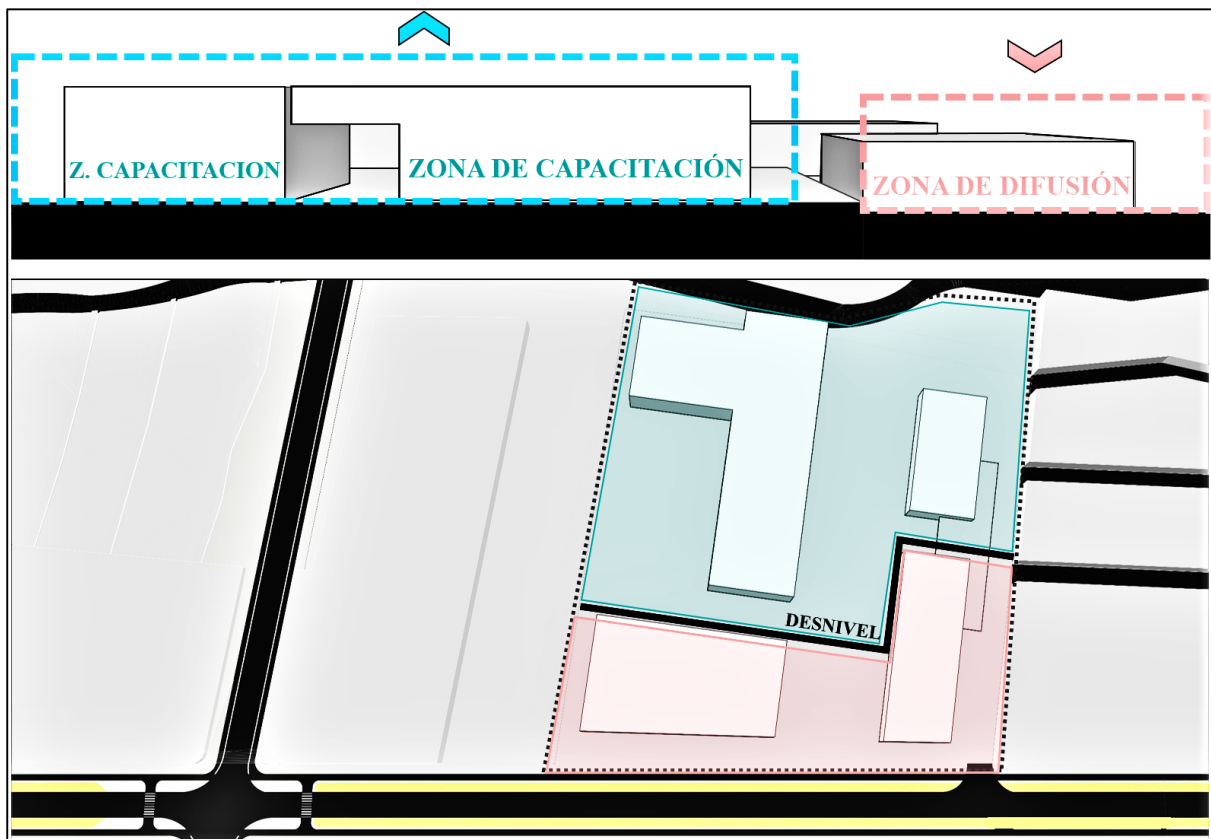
Sección y Planta esquemática del emplazamiento del terreno. Elaboración Propia.
